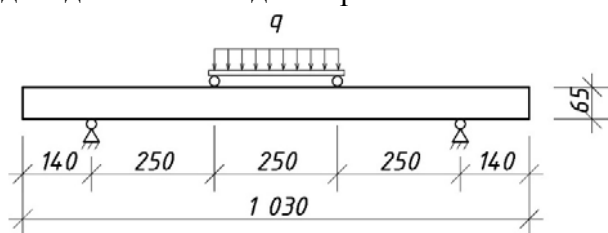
Схема завантаження випробовуваних залізобетонних балок
